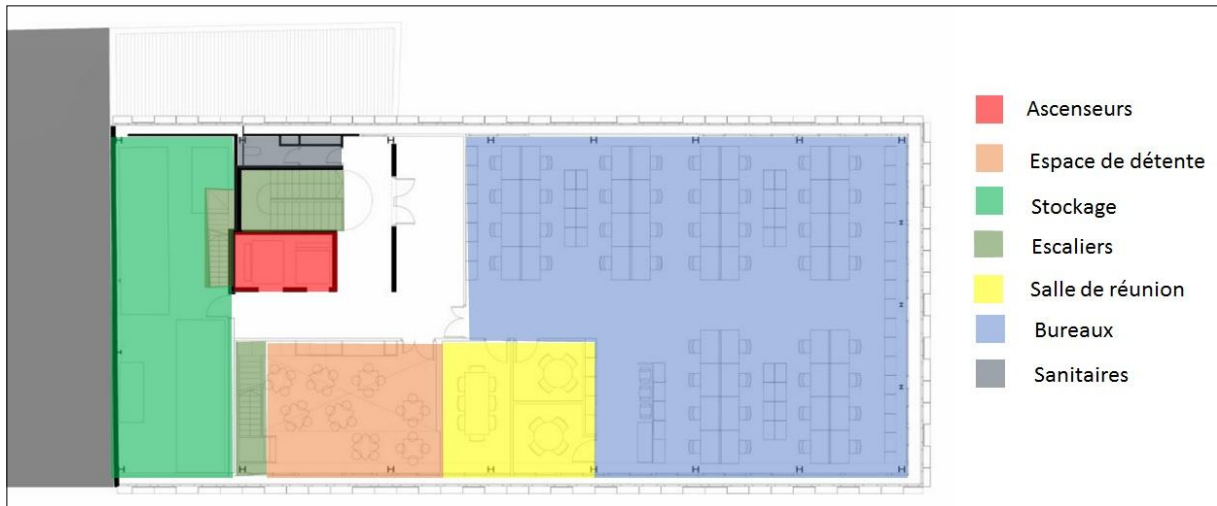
Plan du 3^{ème} et 4^{ème} étage
